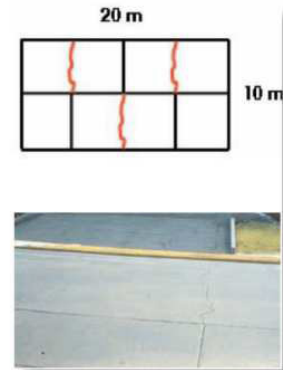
Aparición de fisuras por disponer juntas al tresbolillo.
